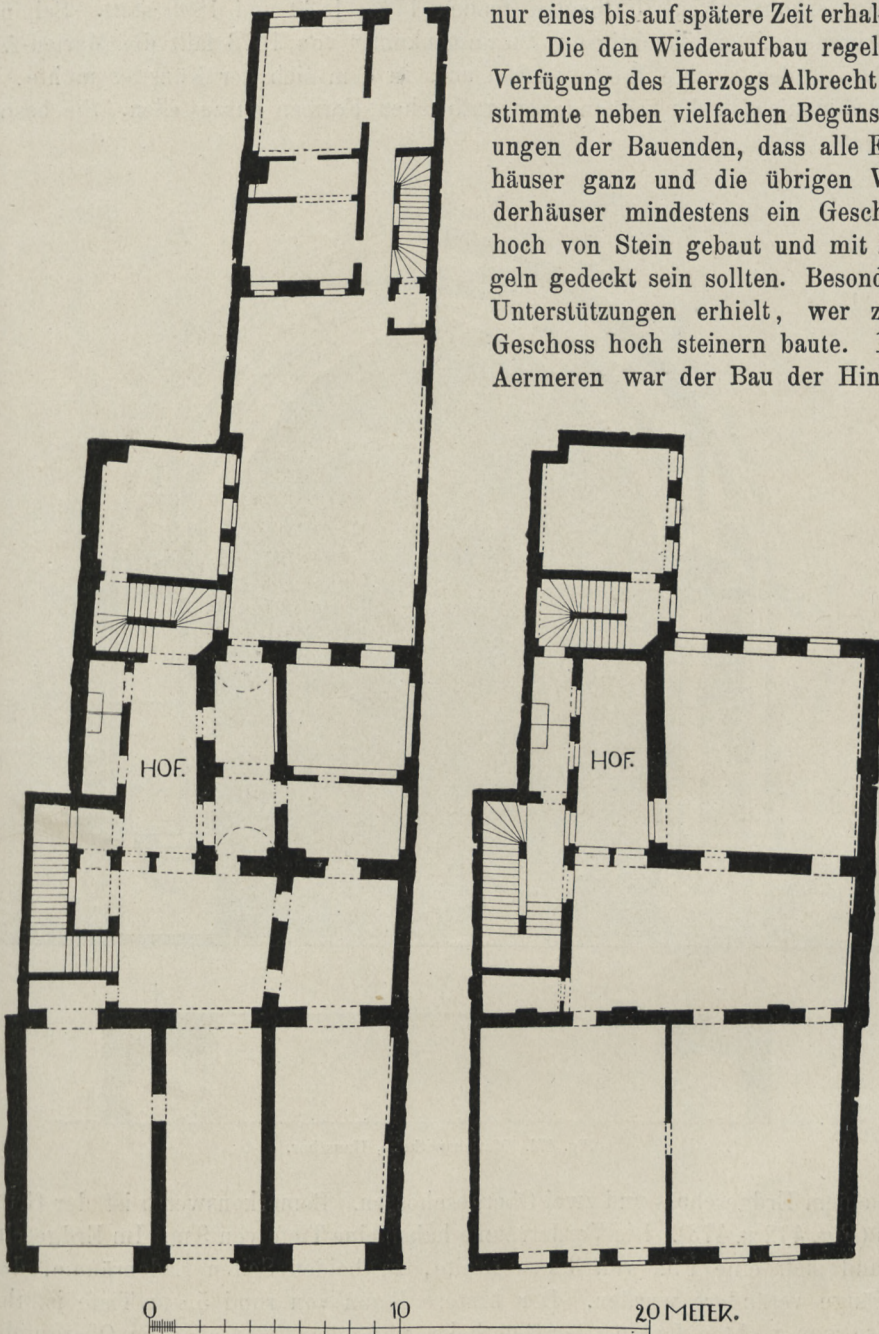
u. 473. Marienapotheke, Grundriss des Erdgeschosses und 1. Obergeschosses.
